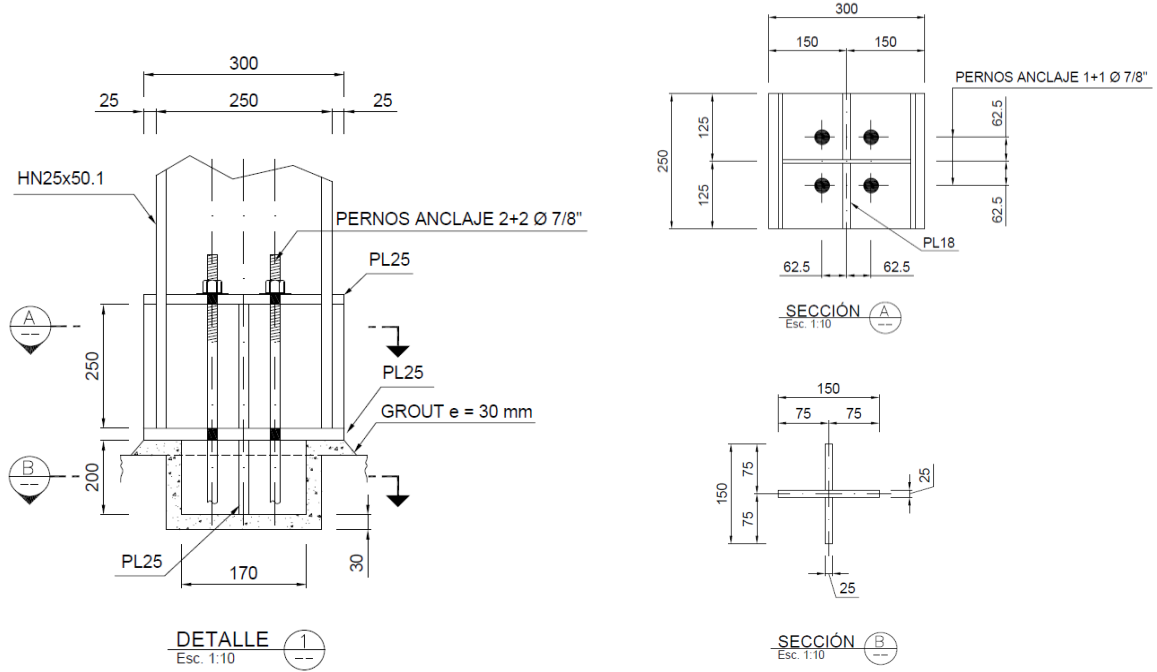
Detalle tipo anclajes para columnas HN25x50.1.
